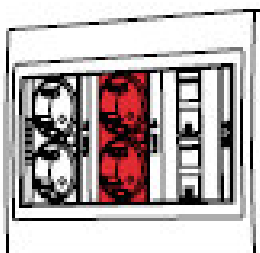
Modelo de caja TIPO A propuesta en proyecto para aulas de primaria.
